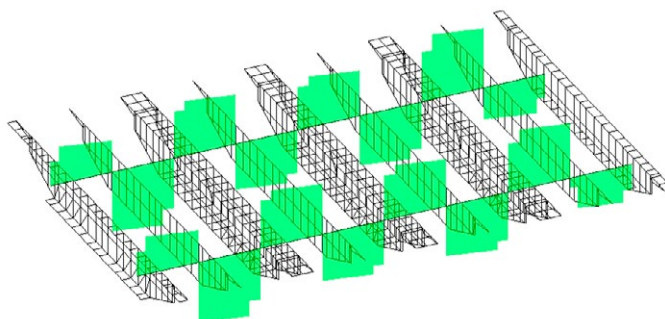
ELU-01 Cortantes de la viga longitudinal.
